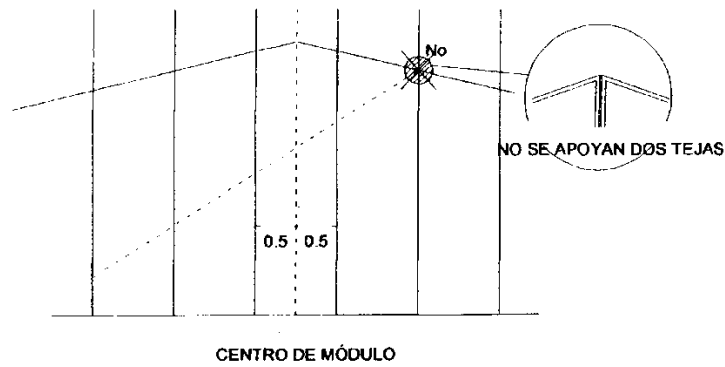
Acople entre planchas y perfiles metálicos.
